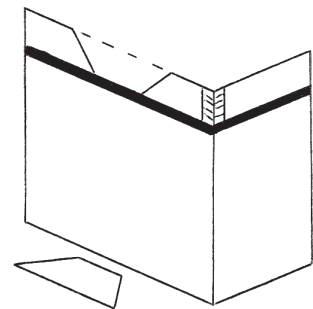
Schéma : renversement des pierres de la couche extérieure de la maçonnerie.
